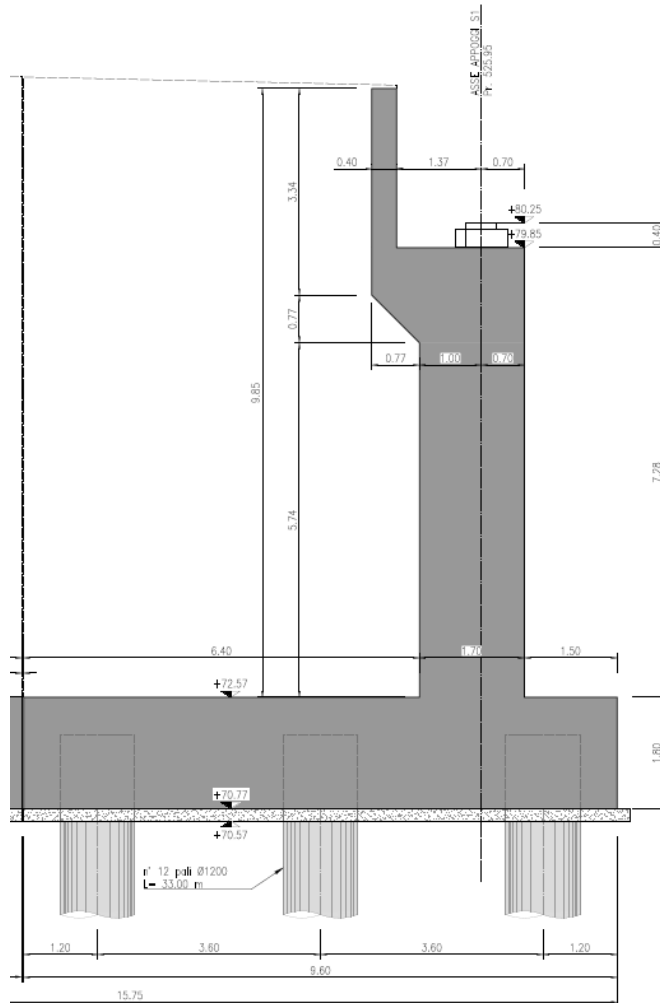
Sezione trasversale muro frontale Spalla S1
